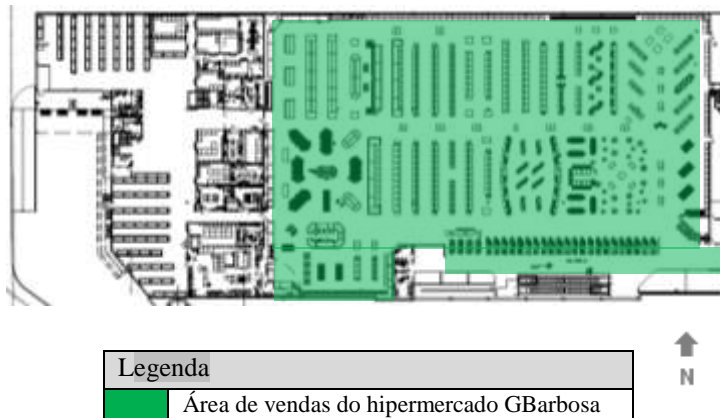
Planta baixa do 1º pavimento do hipermercado GBarbosa.
